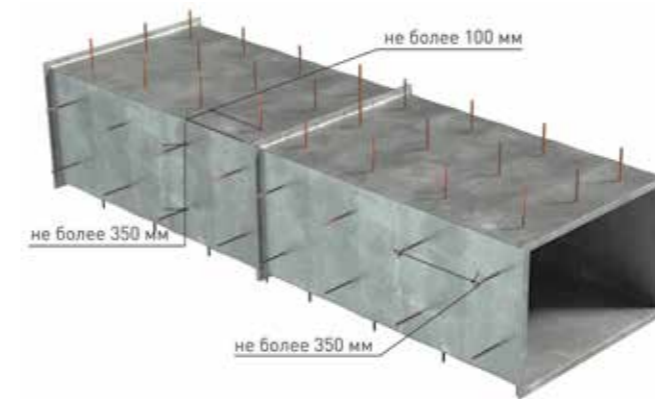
Привязка точек приварки игл к габаритам воздуховода
